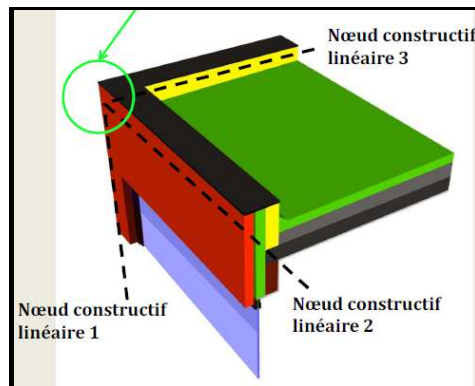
Intersection de 3 nœuds constructifs linéaires : exemple du toit plat
